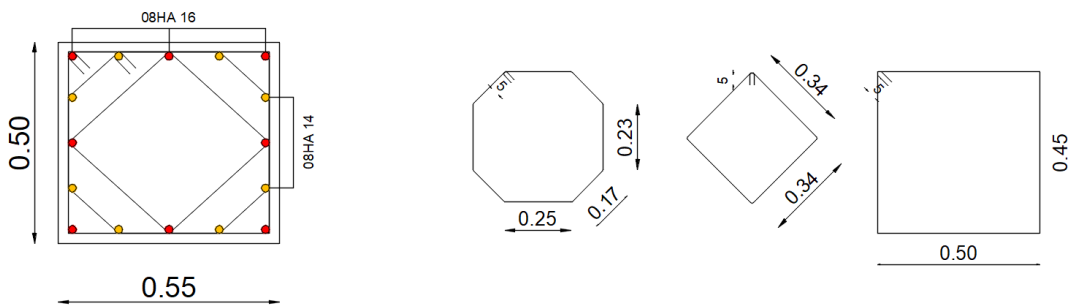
Schéma de ferrailage du poteau (65 x 65 cm<sup>2</sup>)
